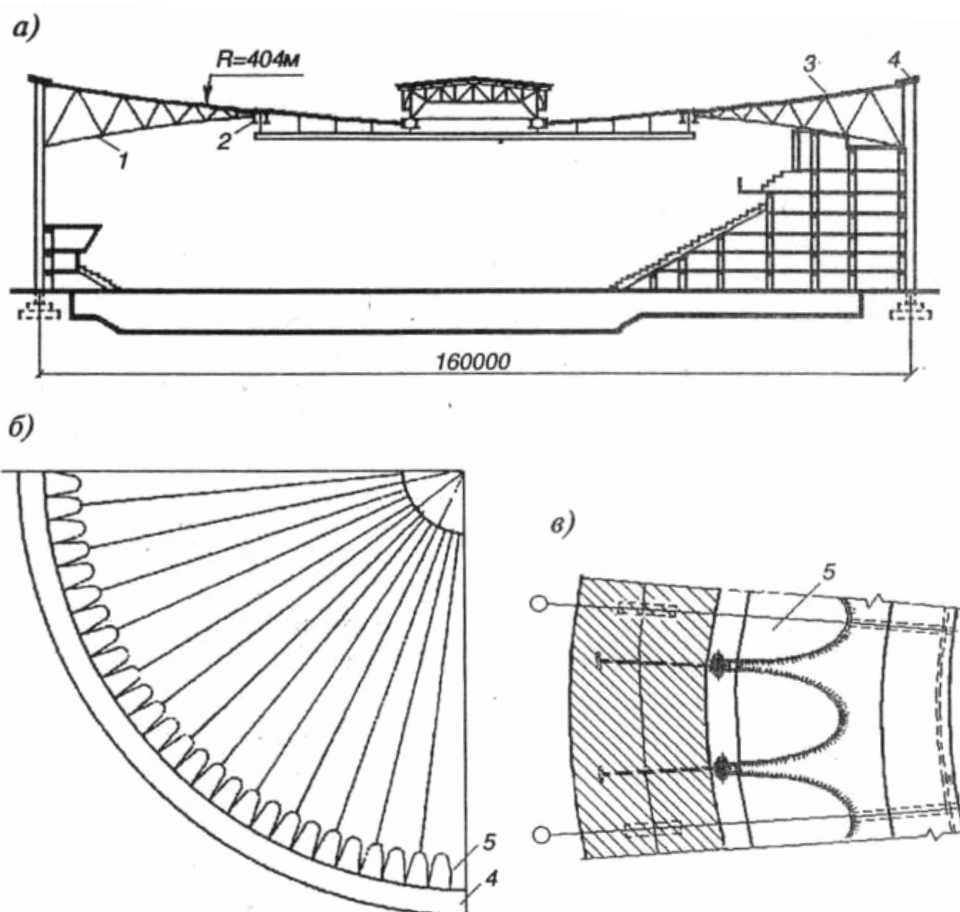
Мембранное покрытие спортивного зала: 1 – стабилизирующая ферма; 2 – промежуточное кольцо; 3 – мембрана; 4 – опорное кольцо; 5 – вырезы в мембране; 6 – железобетонная плита
